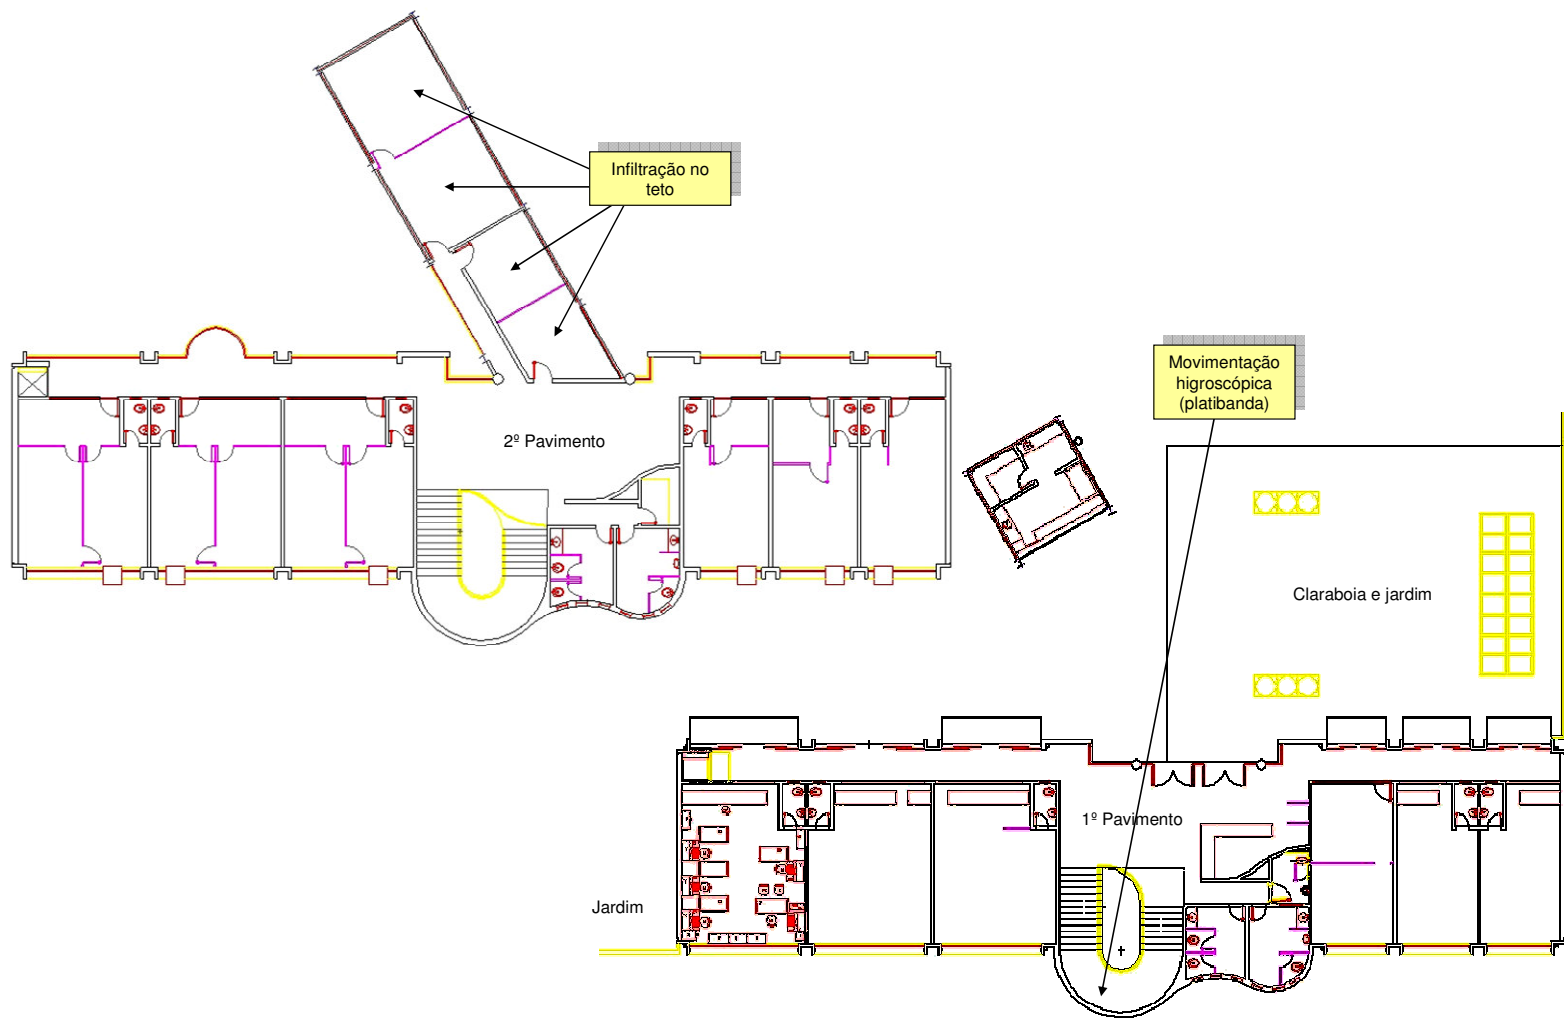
Planta do 1º e 2º Pavimentos e suas patologias.
